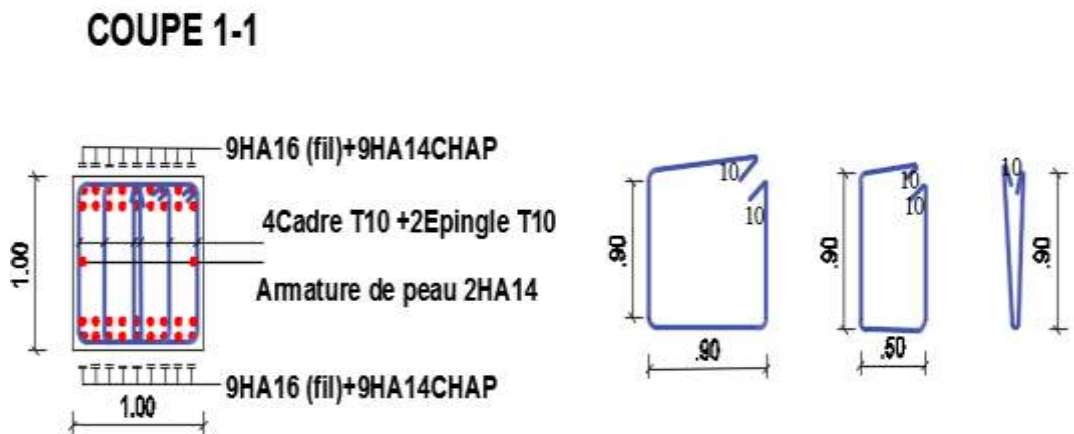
Coupe transversale de ferrailage de la nervure 100 x 100 cm²
